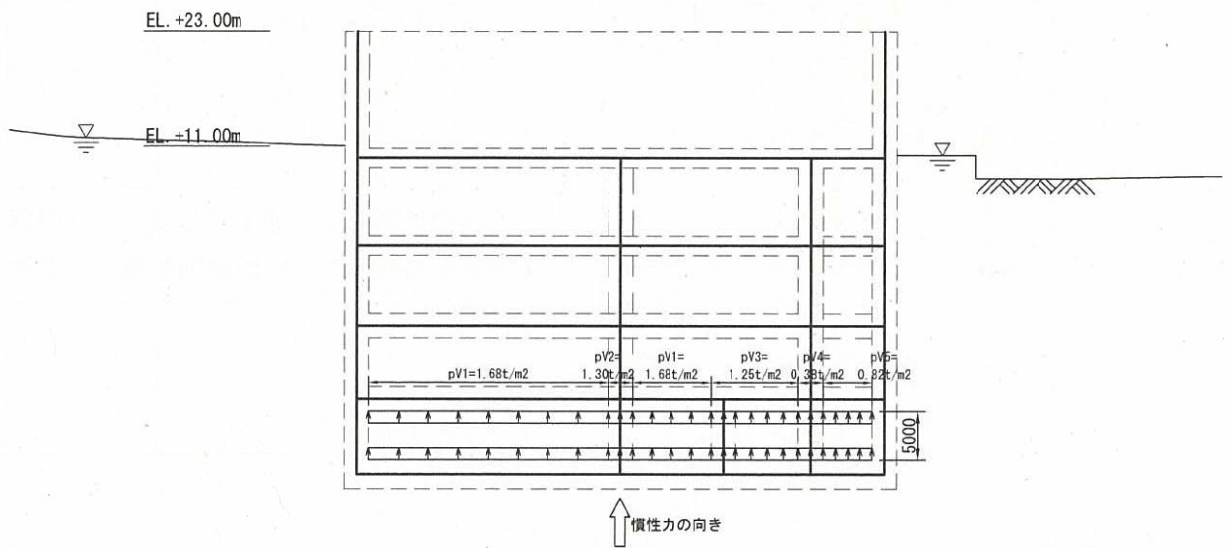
(4) 鉛直動による動水圧図 (東西方向断面)
